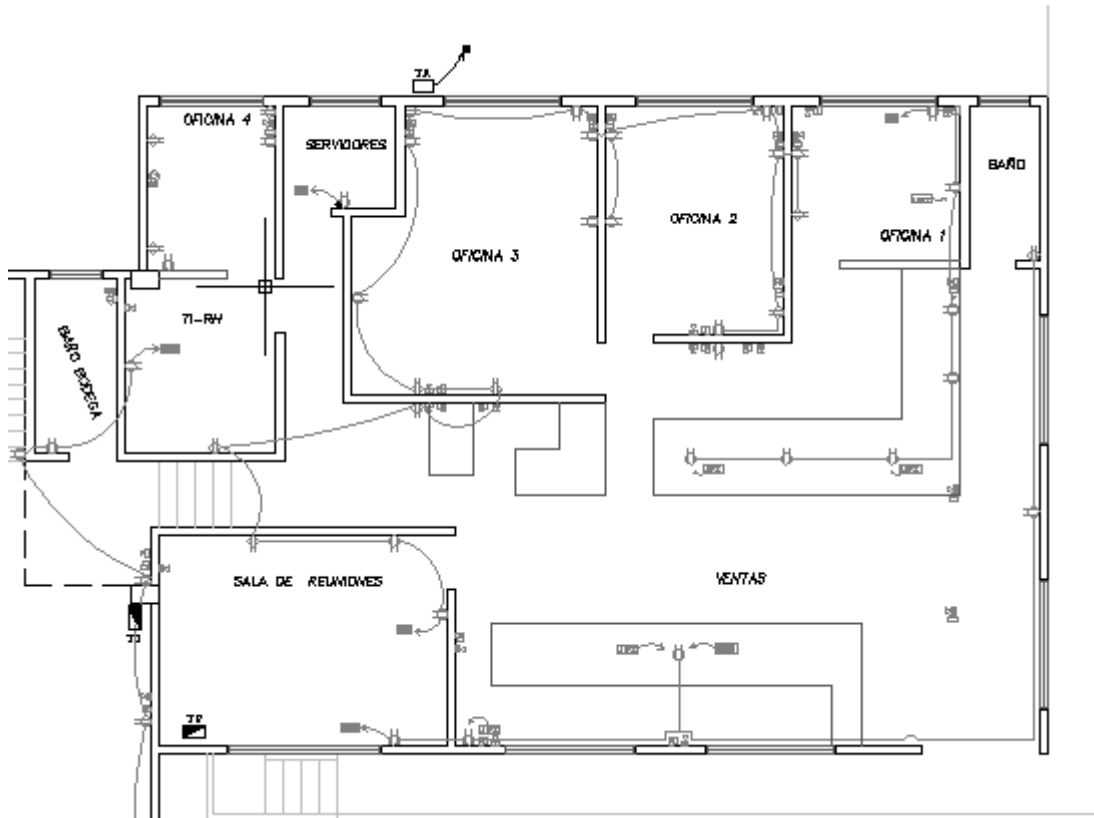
Fragmento de plano eléctrico con el detalle de tomacorrientes.
